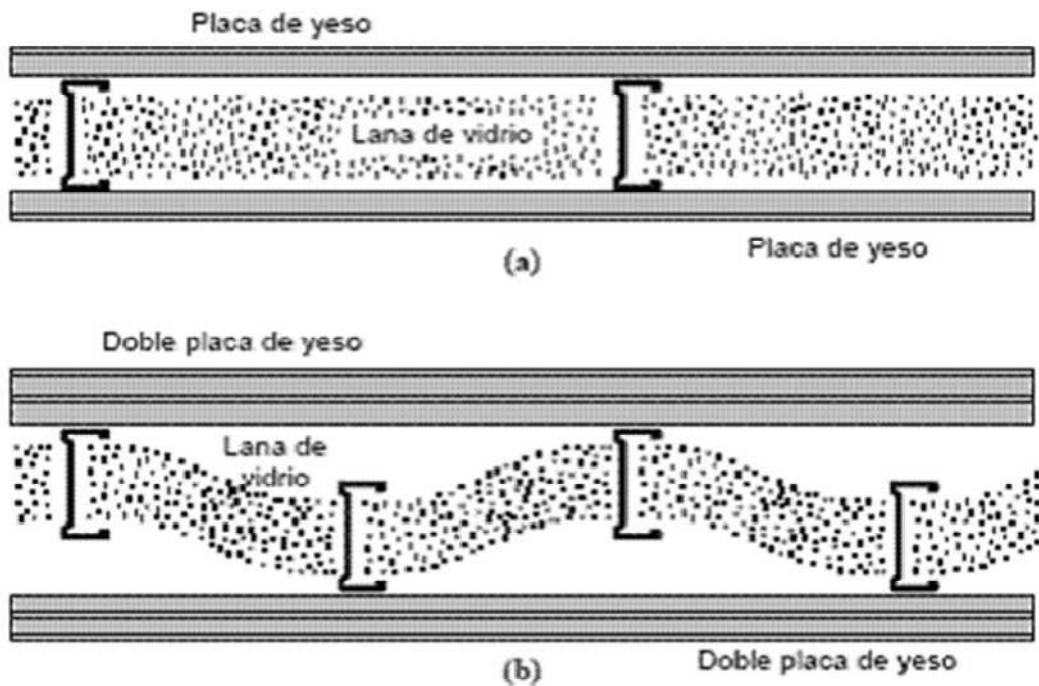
(a) Vista superior en corte de un montaje de placas de roca de yeso con estructura formada por perfiles de chapa. (b) Estructura alternada sin conexión rígida. Notar la diferencia de espesores a uno y otro lado de la pared.
